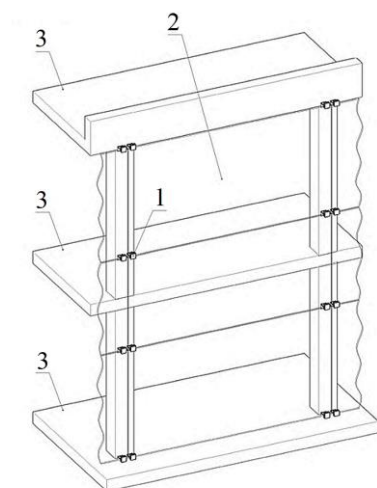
Схема бескаркасной фасадной системы: 1 – элементы крепления; 2 – заполнение; 3 – несущие конструкции здания
